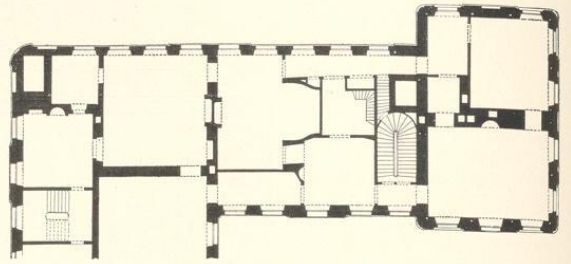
Grundriß des Hauptgeschosses, um 1780
